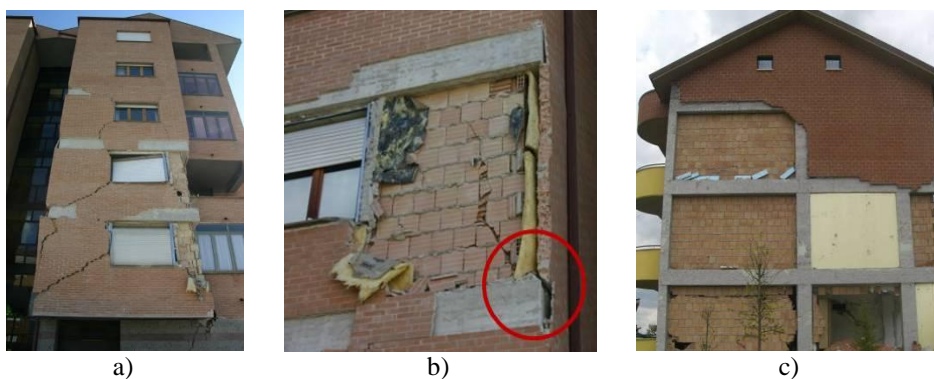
a) Fissuração e b) colapso do pano exterior de parede dupla exterior; e c) desligamento total do pano de parede/revestimento exterior da envolvente
